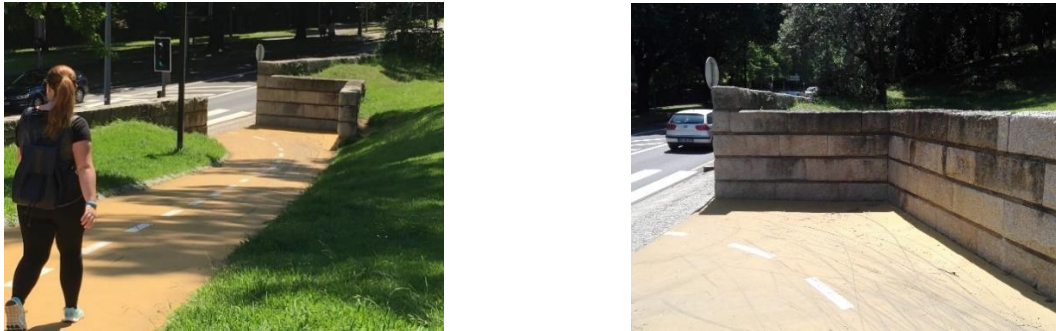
Ponto 7: Mudança na cor do pavimento, marcas de freagem e espaço disponível para elementos de apoio não aproveitado.
